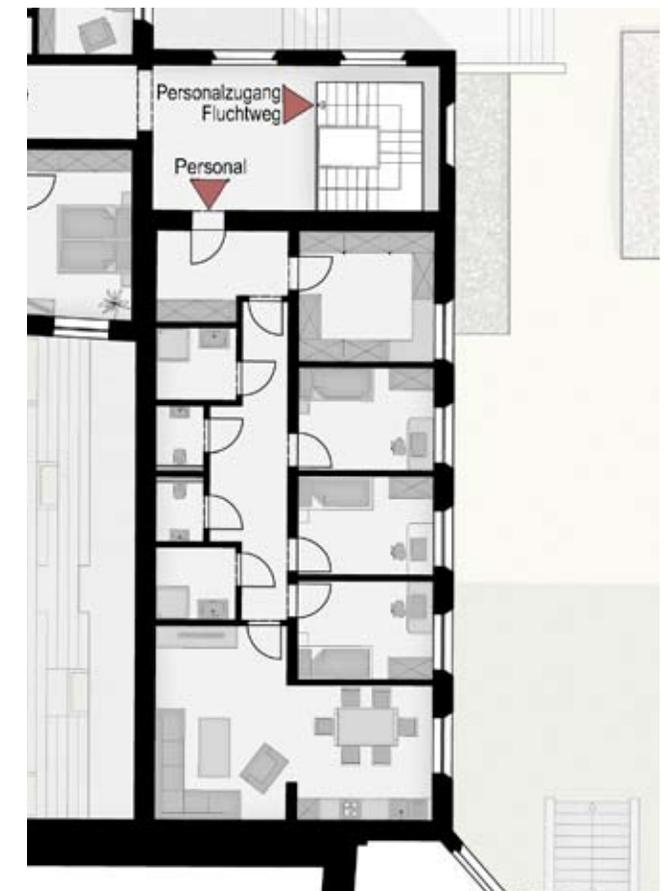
Grundrissdarstellung der Belegsaalräume - Ebene 2, M1:200
